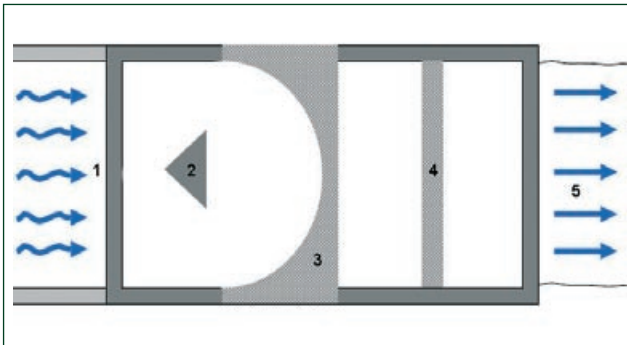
Draufsicht auf Gegenstromtosbecken
